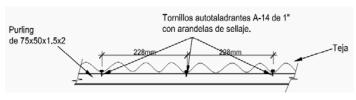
Detalle de la fijación de las tejas o láminas de zinc sobre las viguetas o purlings.
